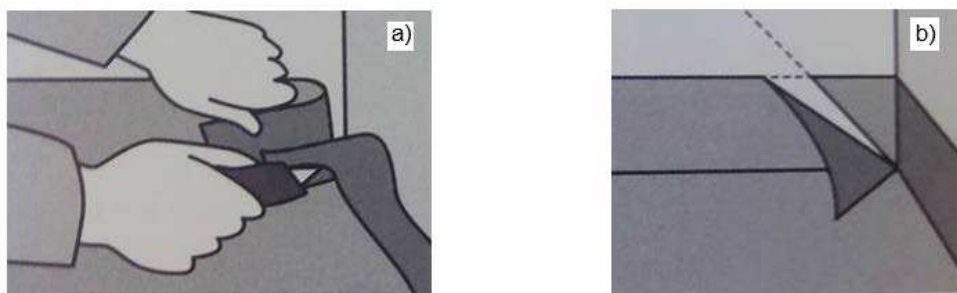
a) Corte a 5mm da superfície [48]; b) Cortes a 45° [48]
